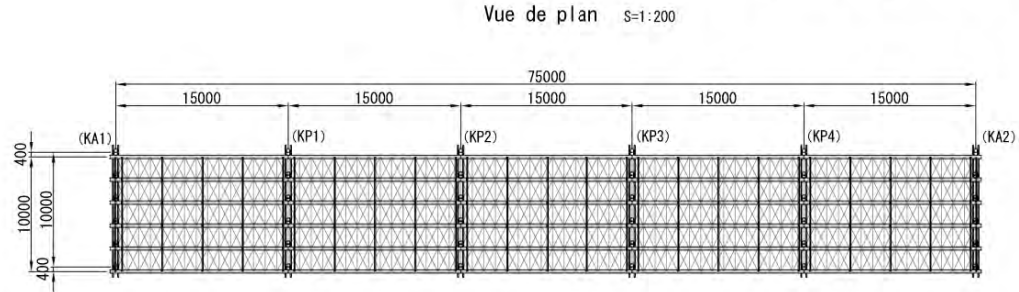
Plan général de l'ensemble du pont provisoire
